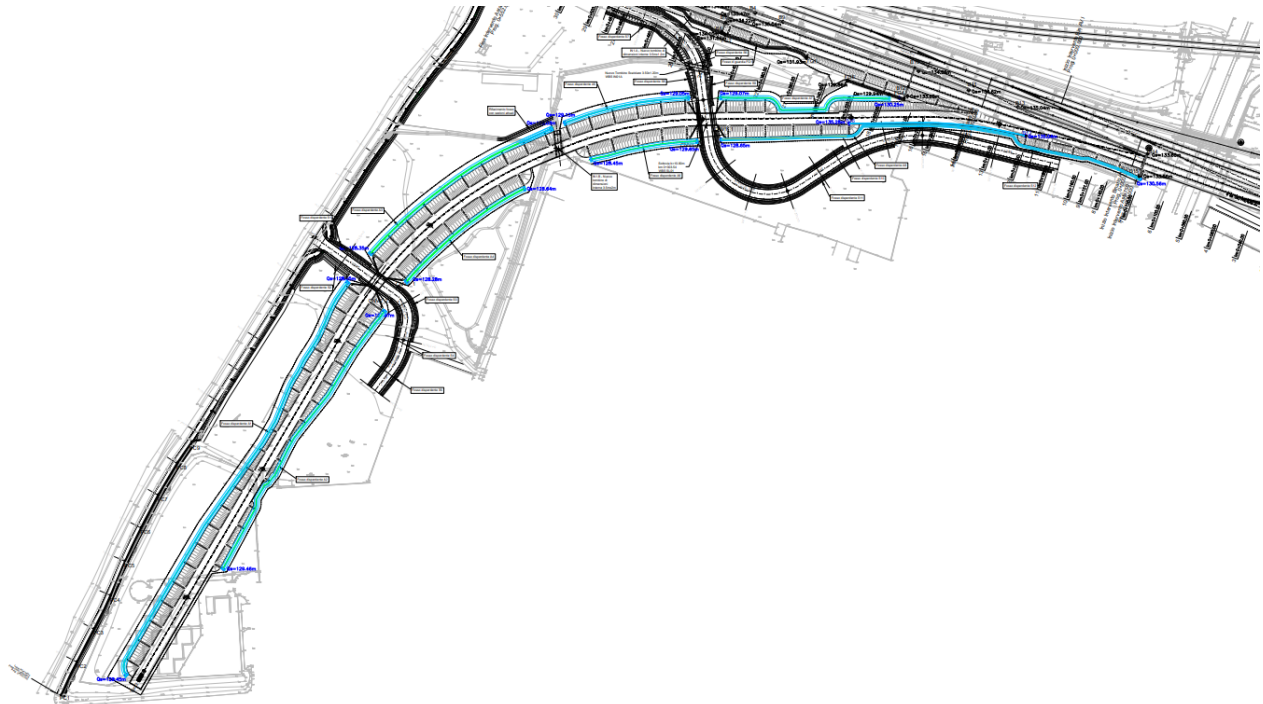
Stralcio planimetria di smaltimento idraulico – Stralcio elaborato IN1M10D26P7ID0002002A
